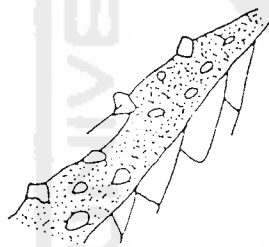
Fill Slope, Failure Reaching Foundation of Rain Water
